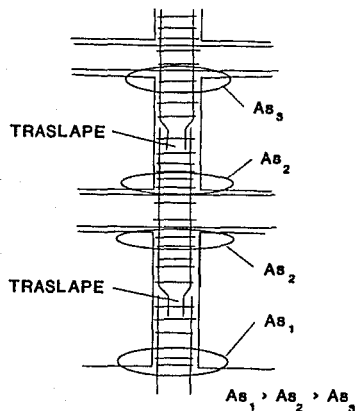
CONSIDERACION DE REFUERZOS EN COLUMNAS
